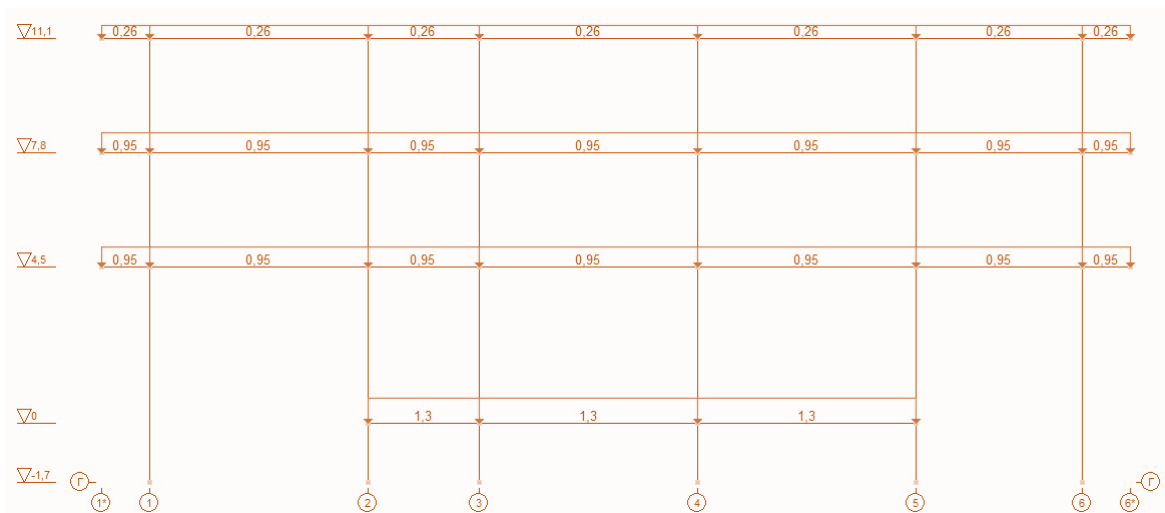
Постійне навантаження від стін із газобетонних блоків
